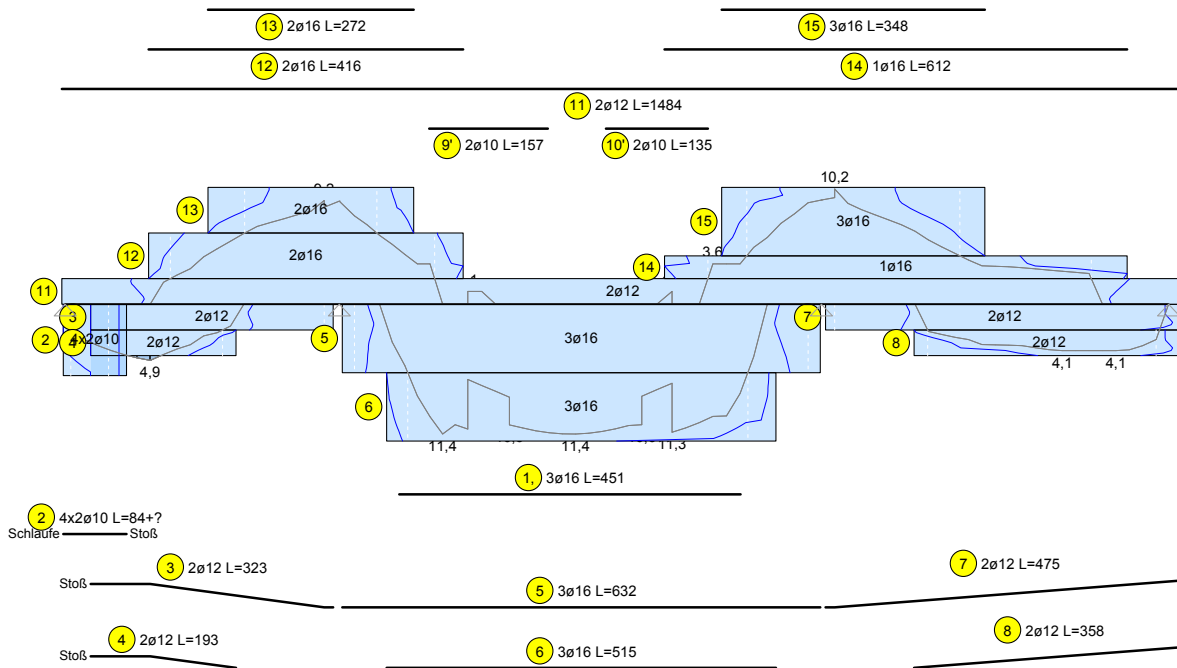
Konstruierte Längsbewehrung. Maßstab 1 : 100, 1cm = 6,67cm².
